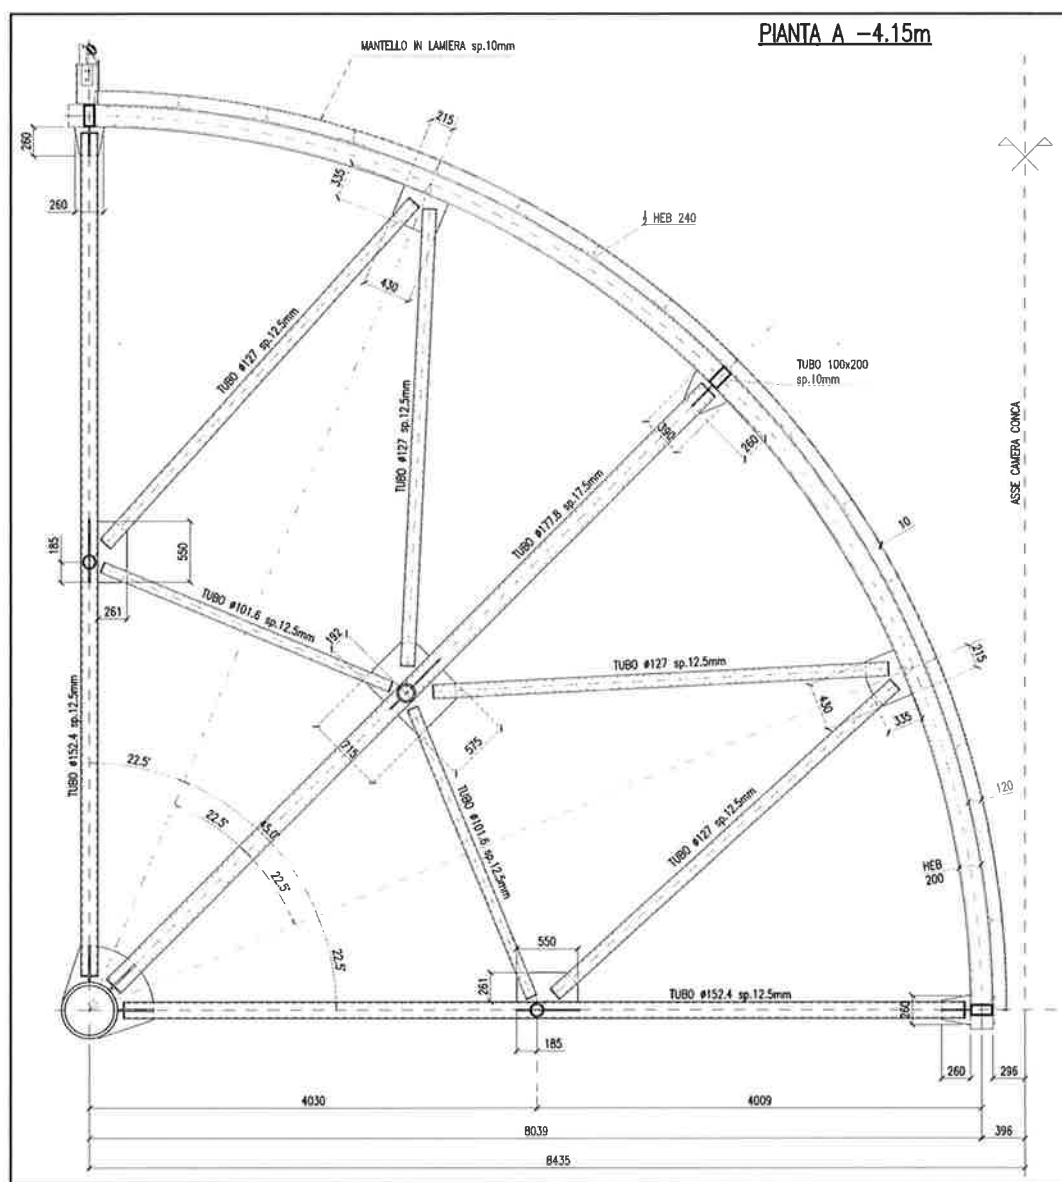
CONCHE DI CHIOGGIA – PIANTA PORTA A QUOTA – 4.15 SLM
